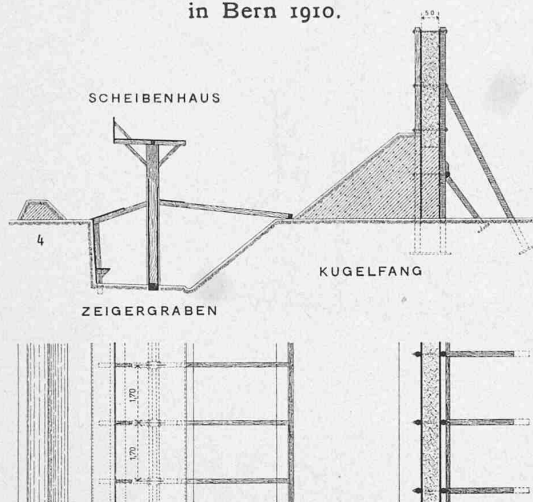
Schnitte und Grundriss vom Scheibenhause und Kugelfang.
